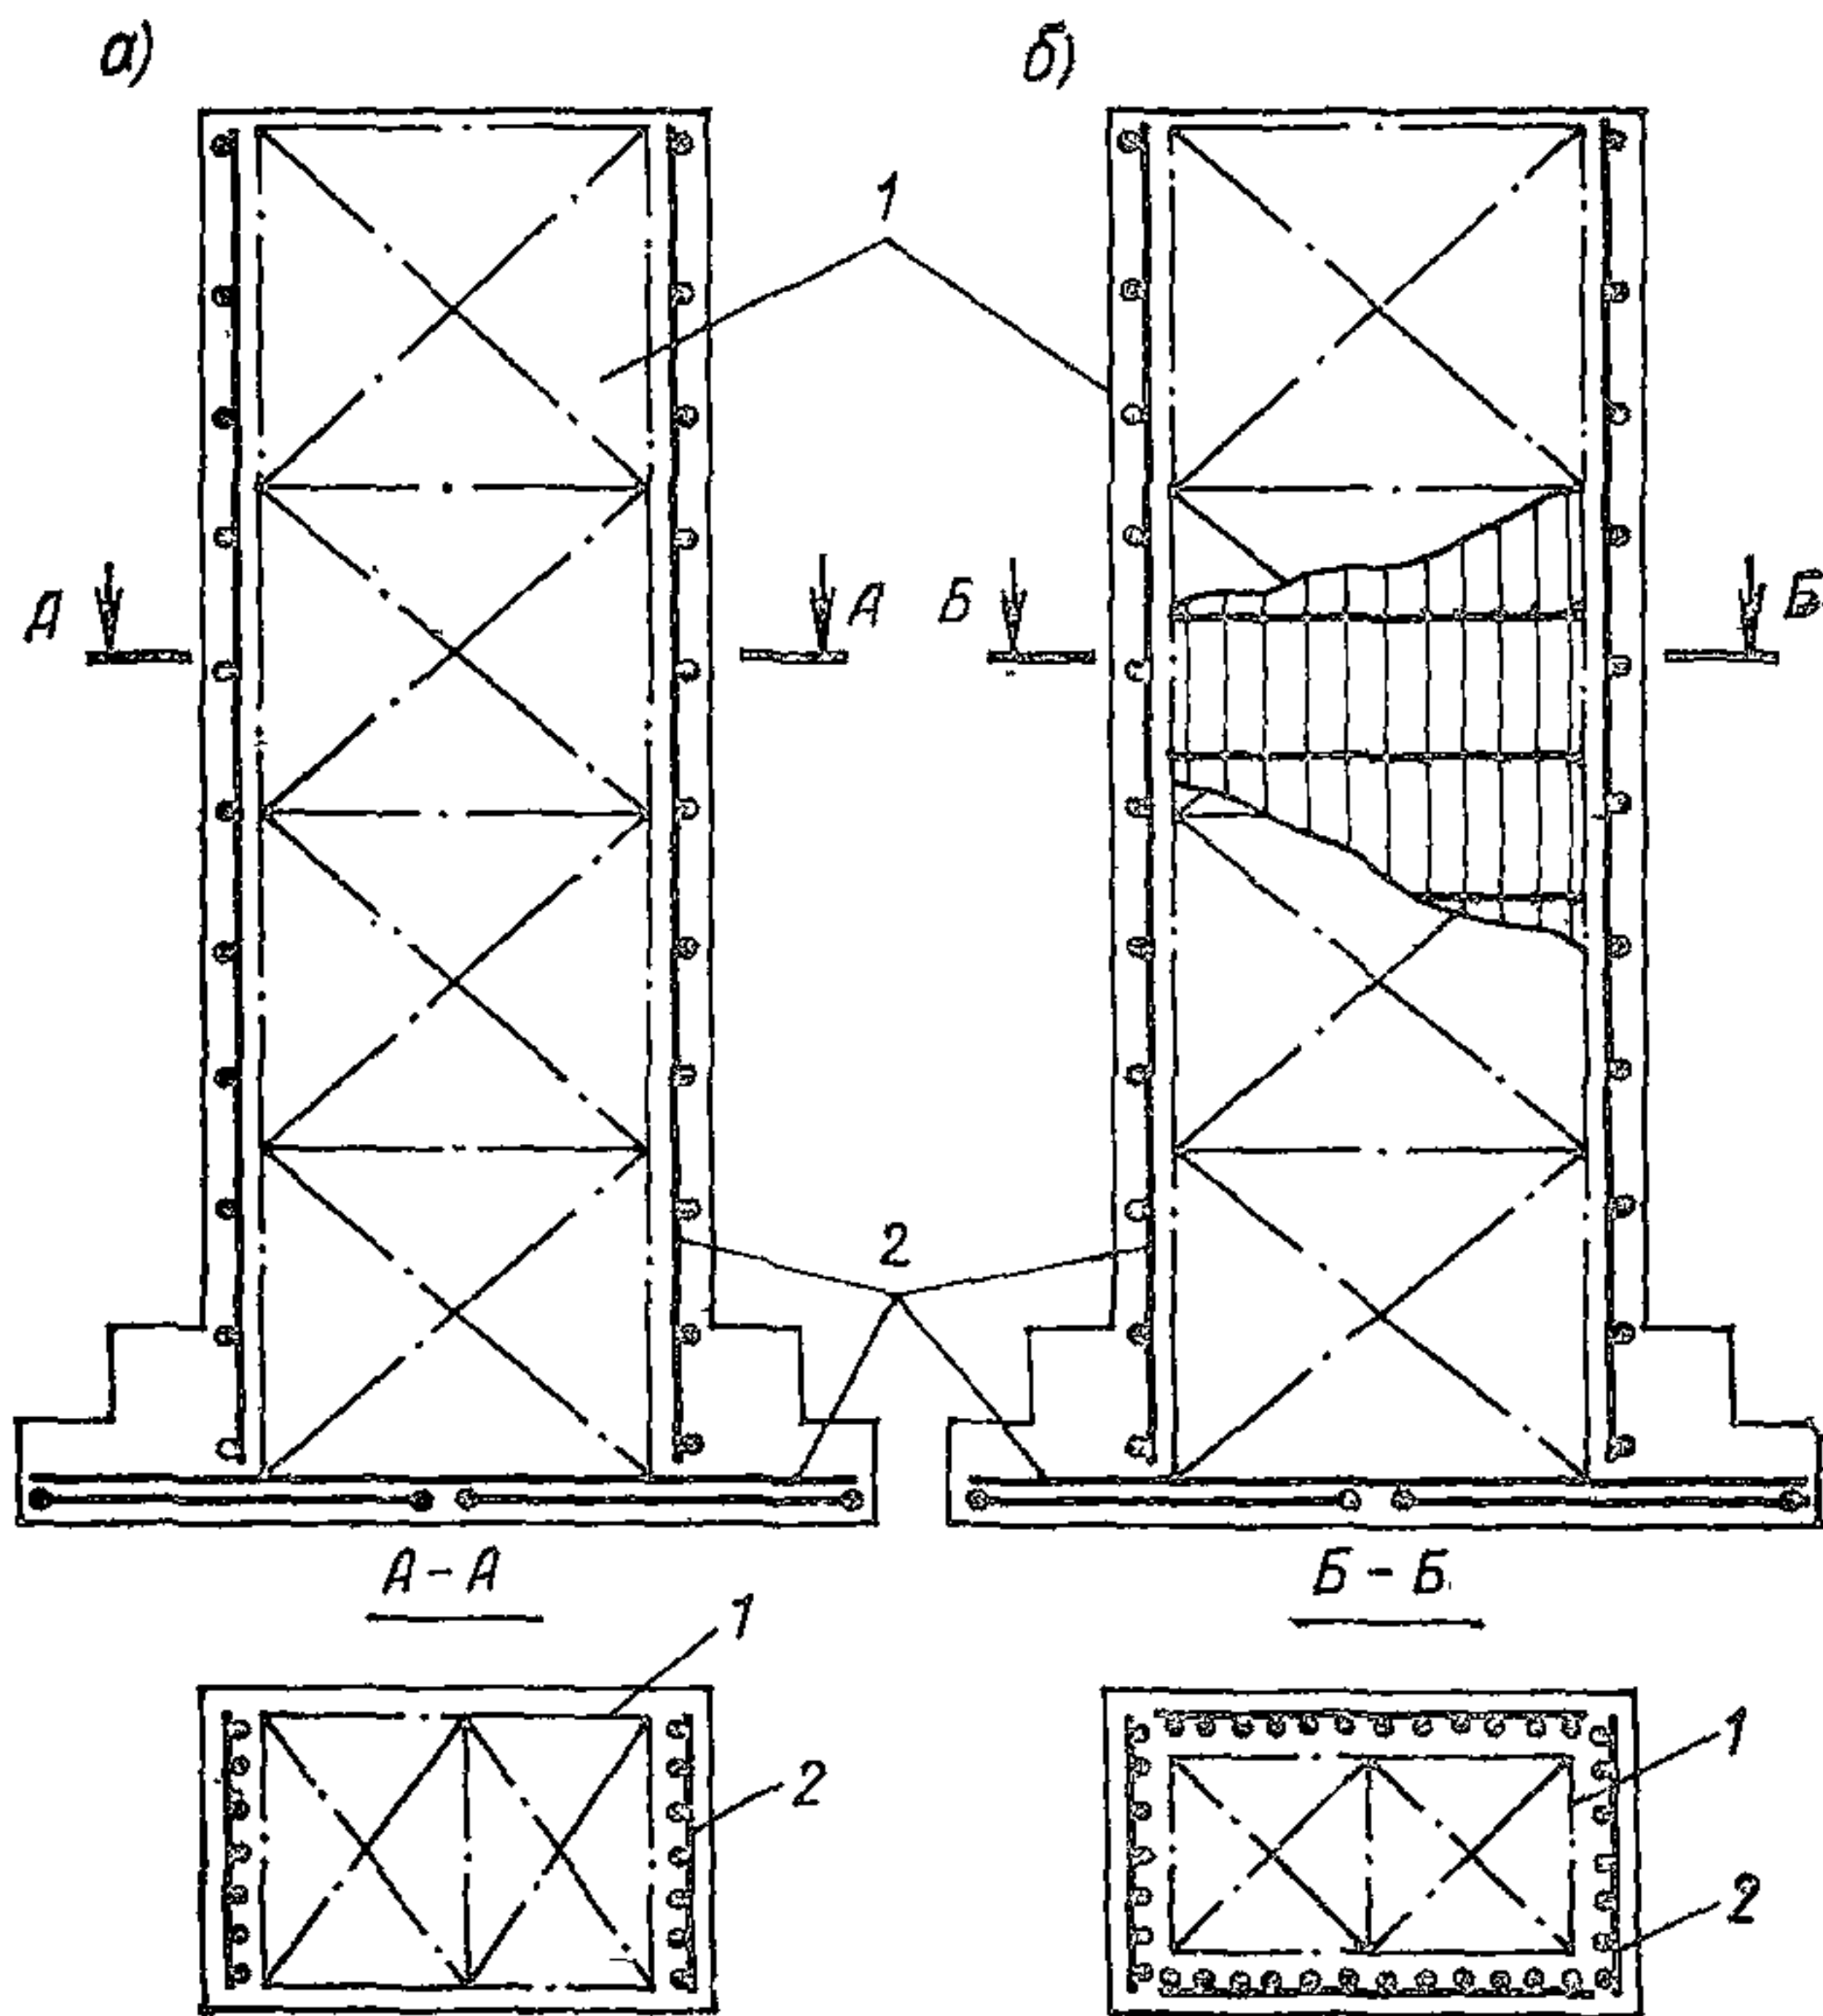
Армирование фундаментов колонн цеха сварными сетками с навеской их на несущий пространственный каркас
